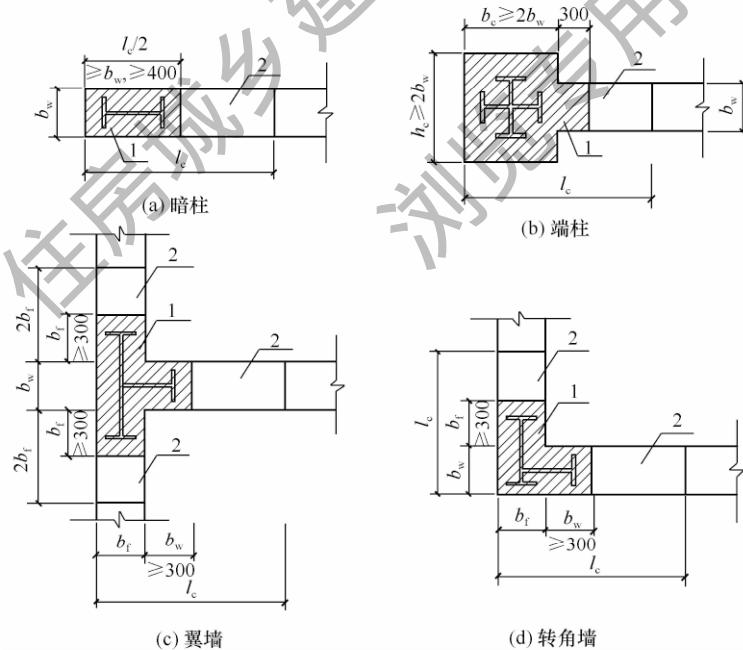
型钢混凝土剪力墙约束边缘构件
